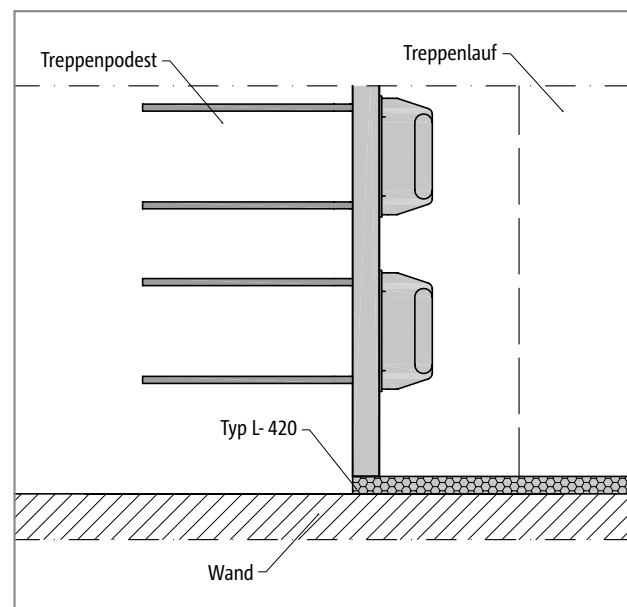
Schöck Tronsole® Typ T: Elementanordnung Detail B
